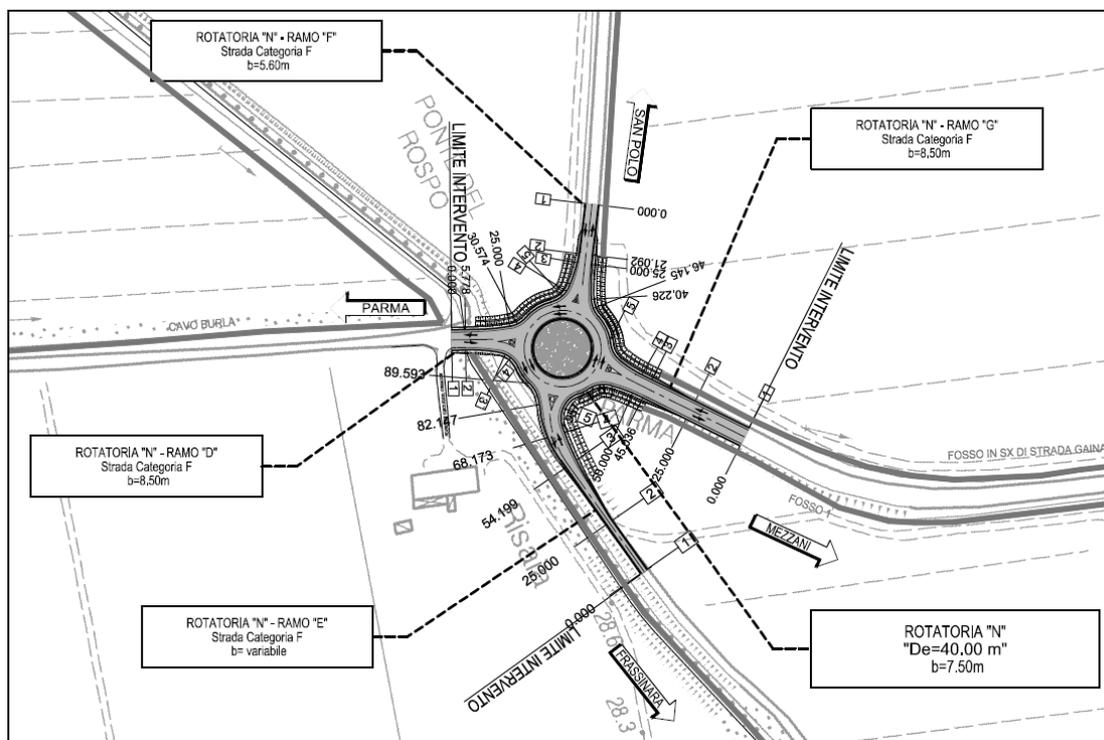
PLANIMETRIA DI PROGETTO – TRATTO 2
